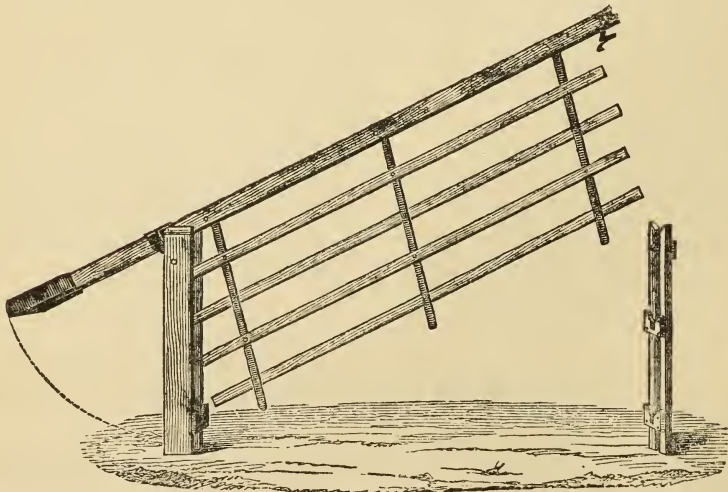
Barrière à soulèvement, à demi ouverte.
